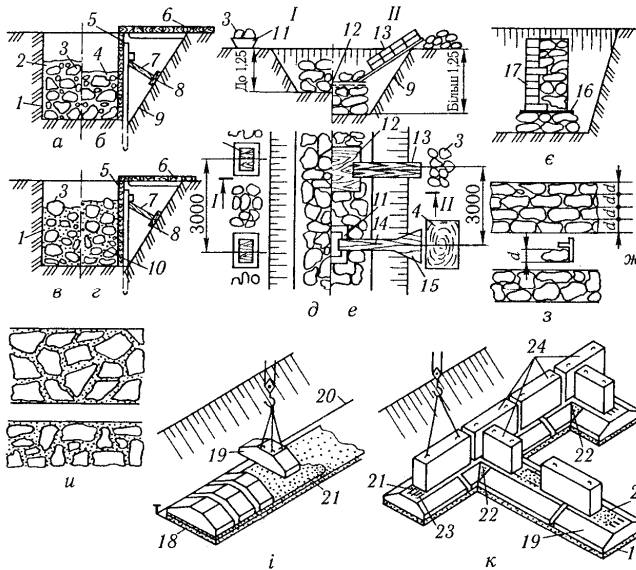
Зведення конструкцій підземної частини будівлі з бутового каменю і великих бетонних блоків:
